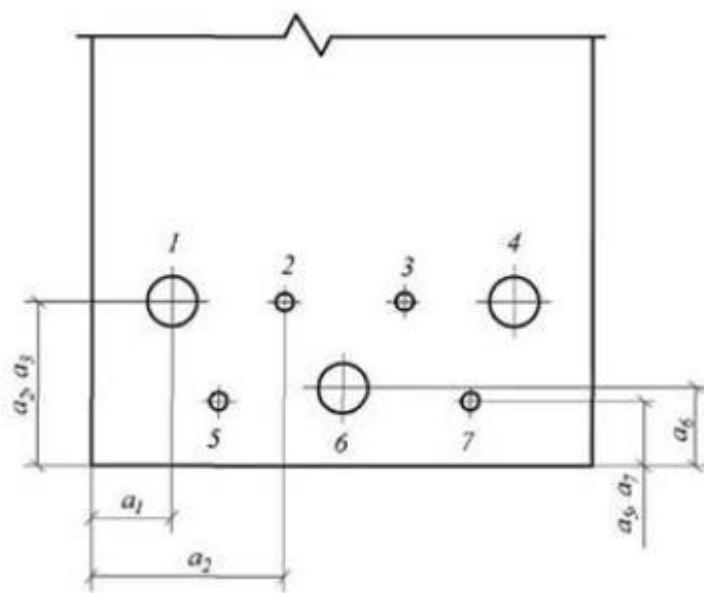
Среднее расстояние до оси арматуры
